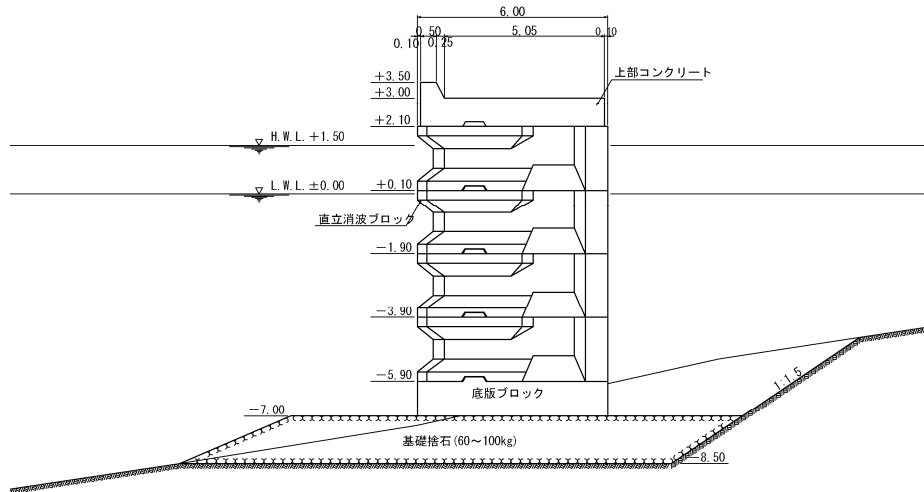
22 No. 2 中央船溜防波堤Aの断面図 (被災前)
